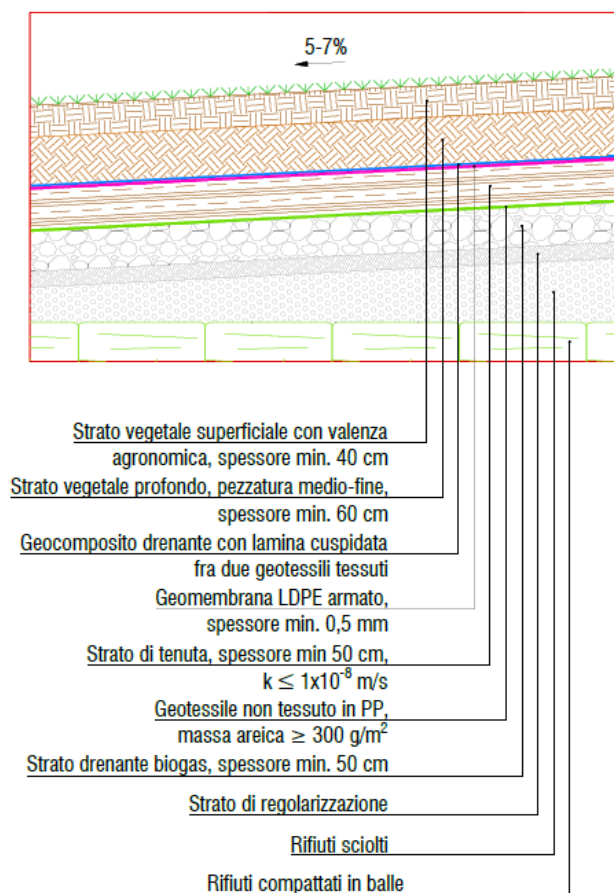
Estratto da T11 - particolare pacchetto di copertura
